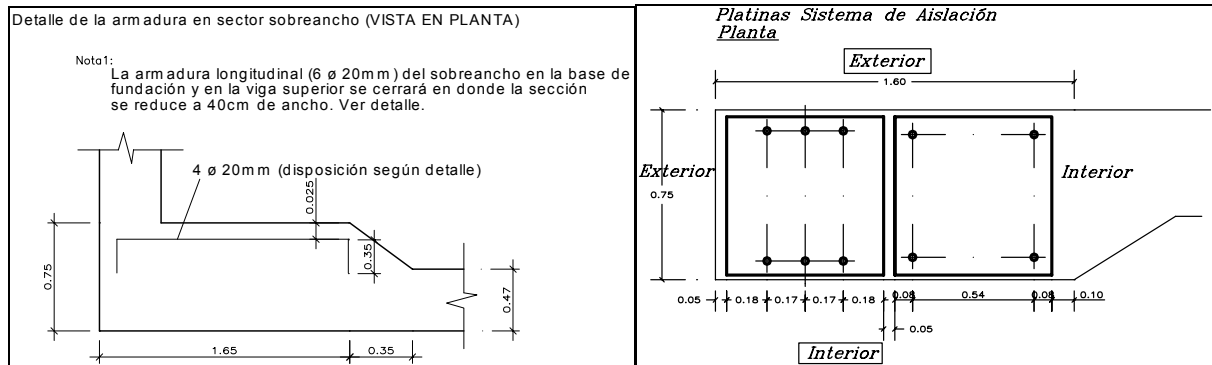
d: Planta que muestra el engrosamiento de la viga de fundación en la zona de emplazamiento del sistema de aislamiento. Ubicación de las platinas de anclaje del sistema de aislamiento en viga de fundación.
